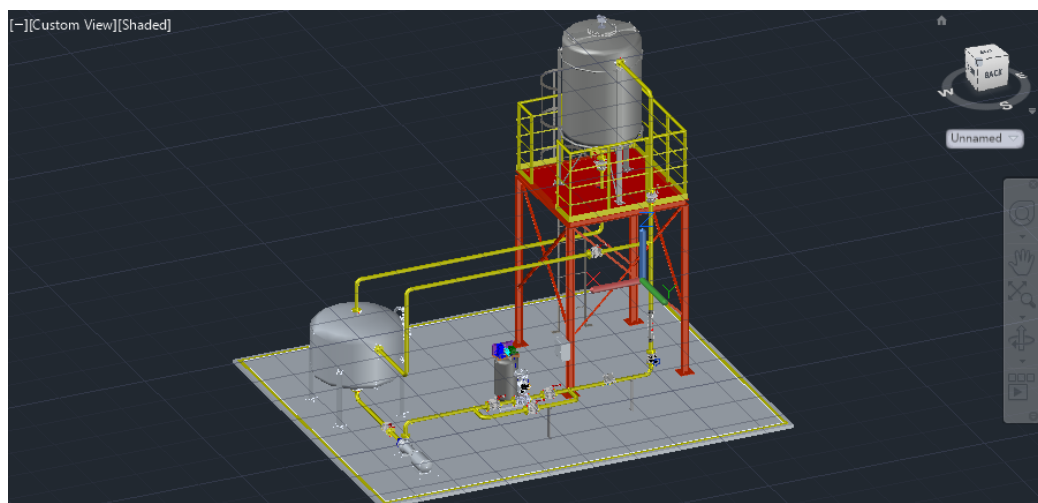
Diseño preliminar de la planta en Autocad Plant 3D
